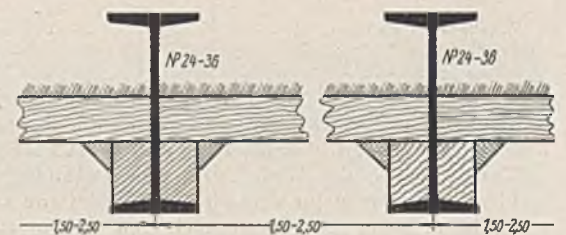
Schnitt durch die Gleisbrücke mit Auflager.
